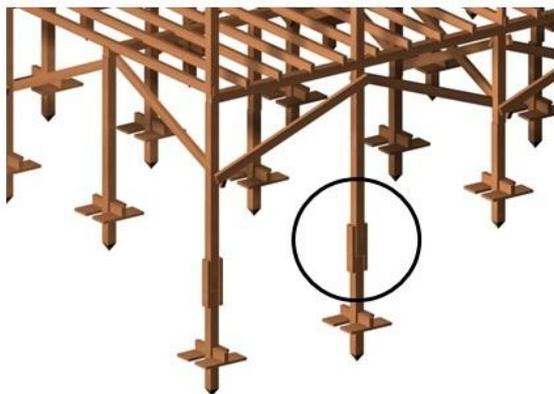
Pondasi kalang sunduk titik yang terlepas dari tanah
